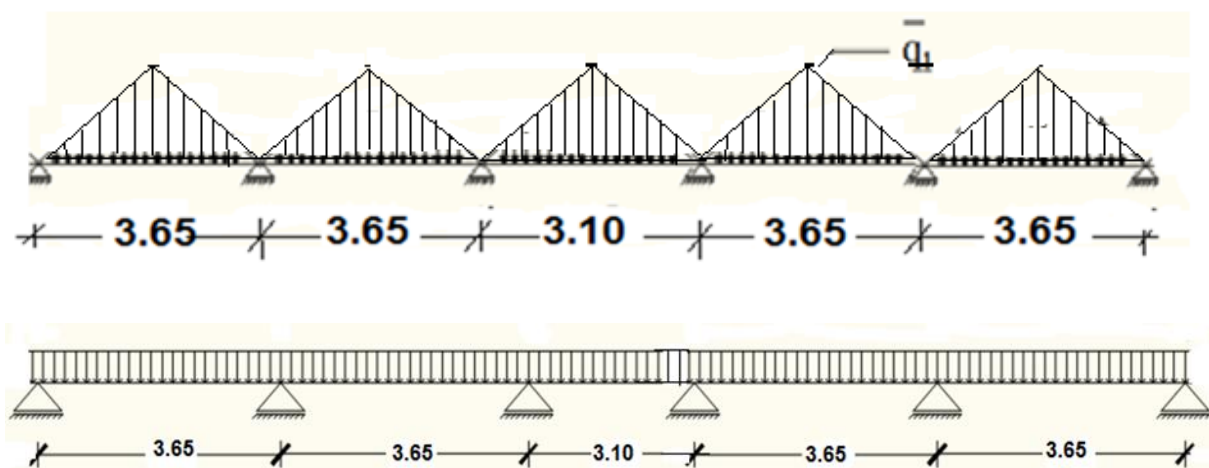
Distribution des charges sur les poutres secondaires.
